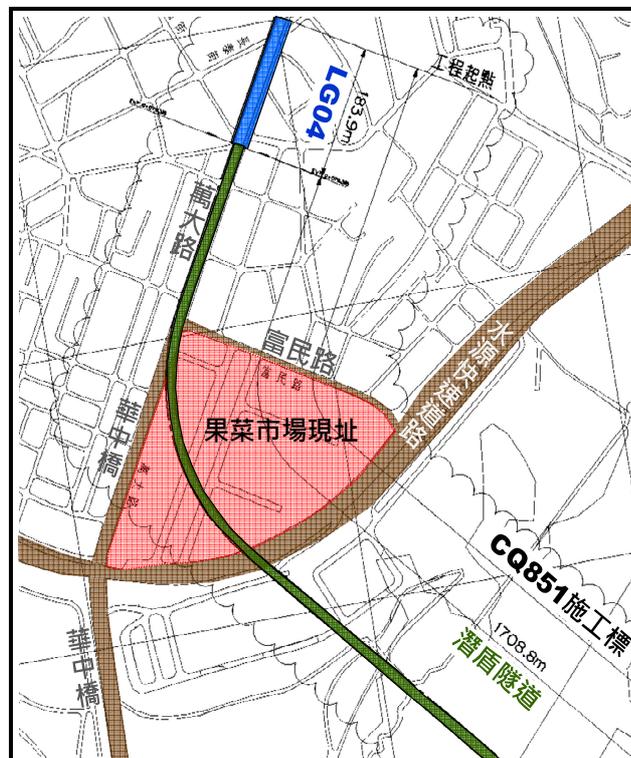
捷運萬大線穿越本計畫基地平面示意圖
